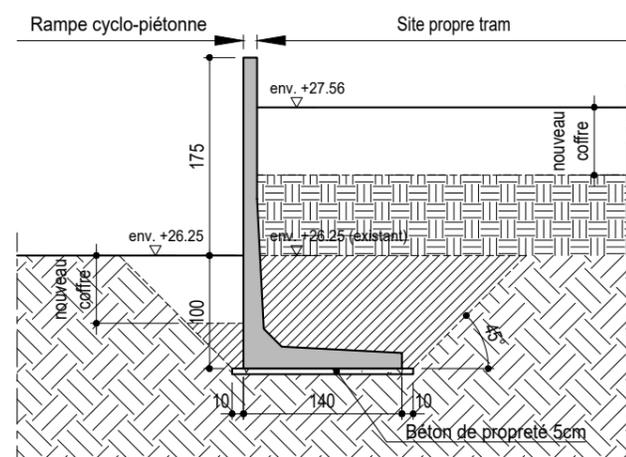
Ransbeek - Principe de soutènement entre la rampe tram et la rampe cyclo-piétonne
